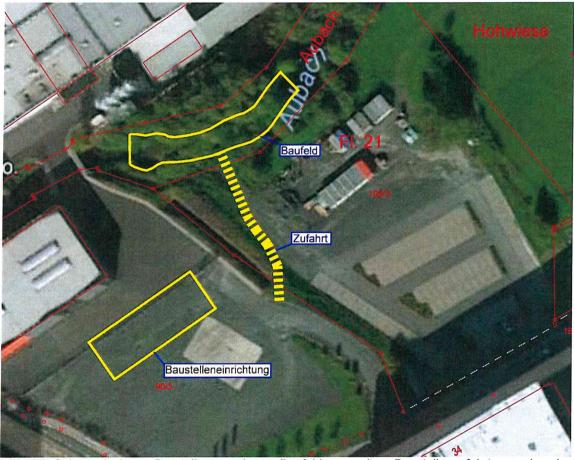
Schematische Darstellung des Baufeldes mit Baustellenzufahrt und der Baustelleneinrichtungsfläche
